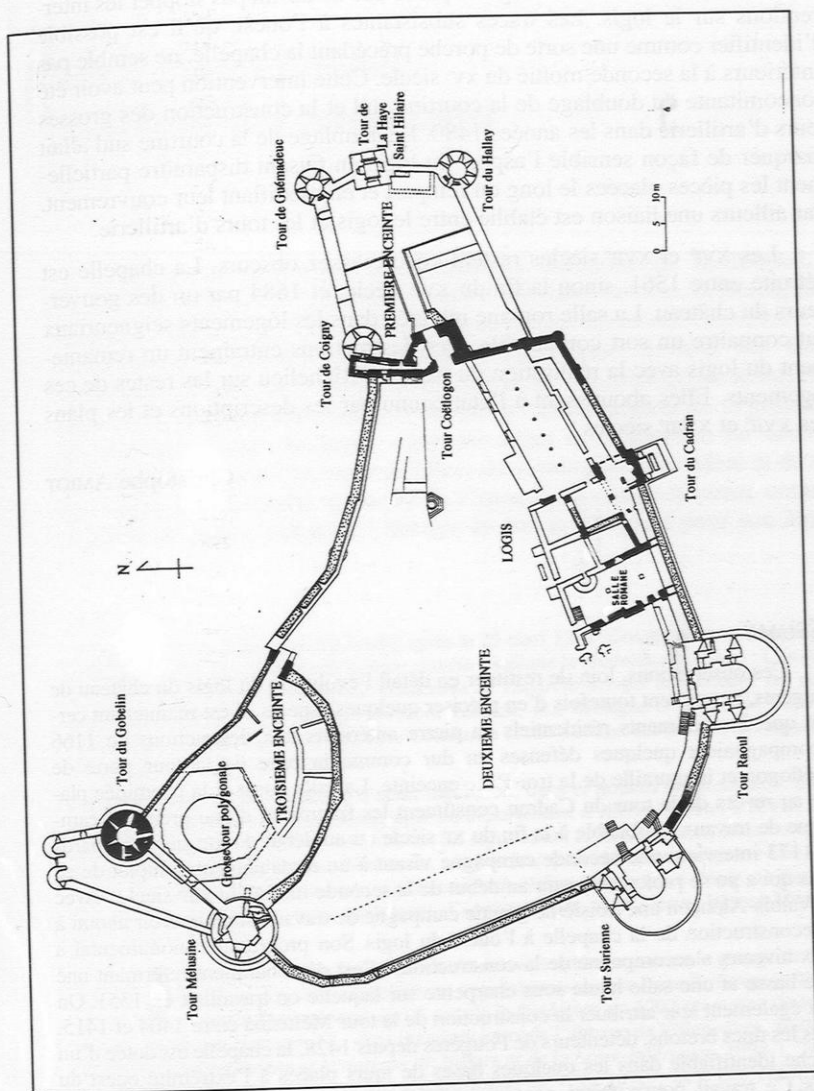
Fougères (Ille-et-Vilaine). Plan d'ensemble du château
